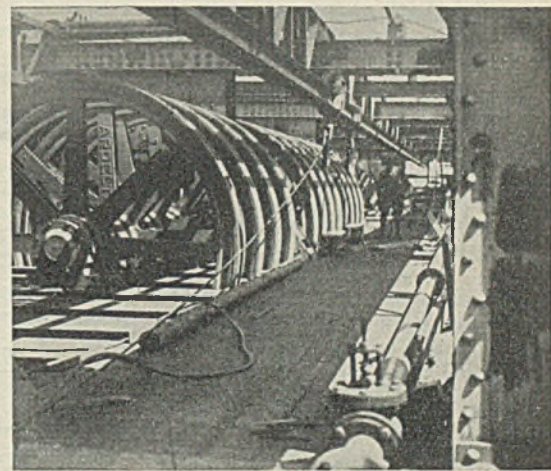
Seilscheiben im Dachgeschoß d. Hebewerkes.
